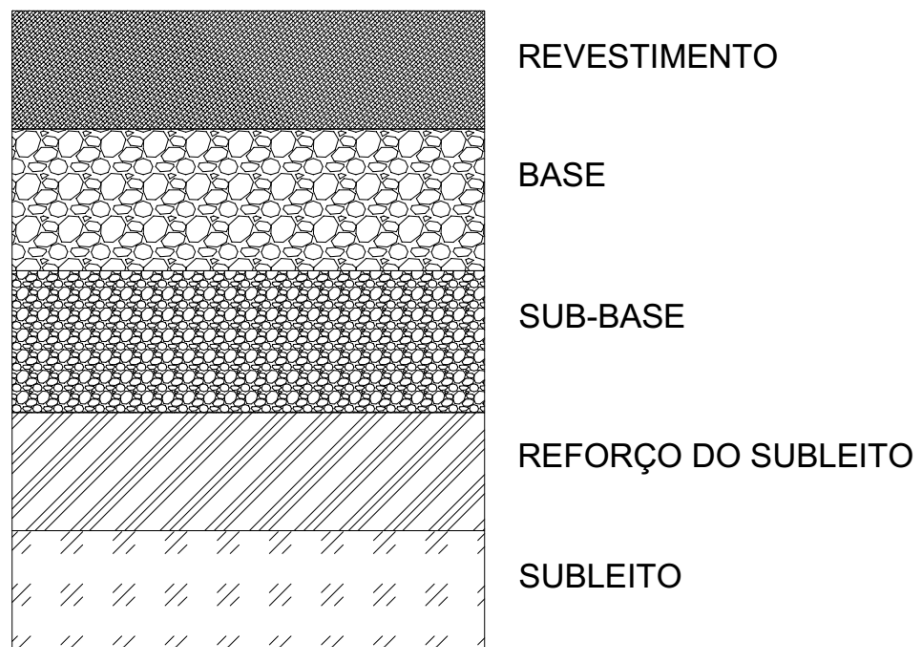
Camadas genéricas de um pavimento. Fonte: O autor (2017).
